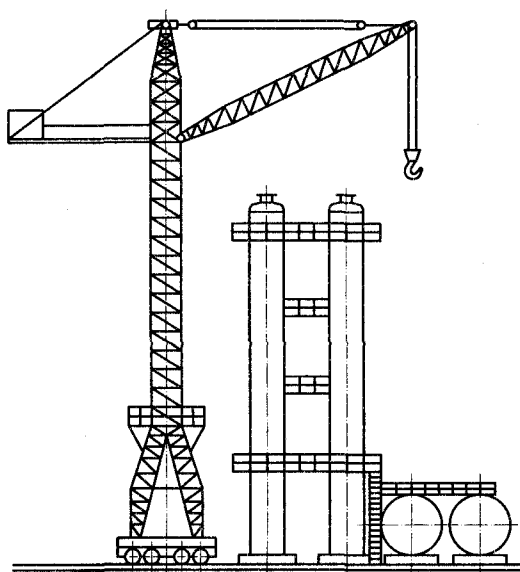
Монтаж оборудования с помощью башенного крана
